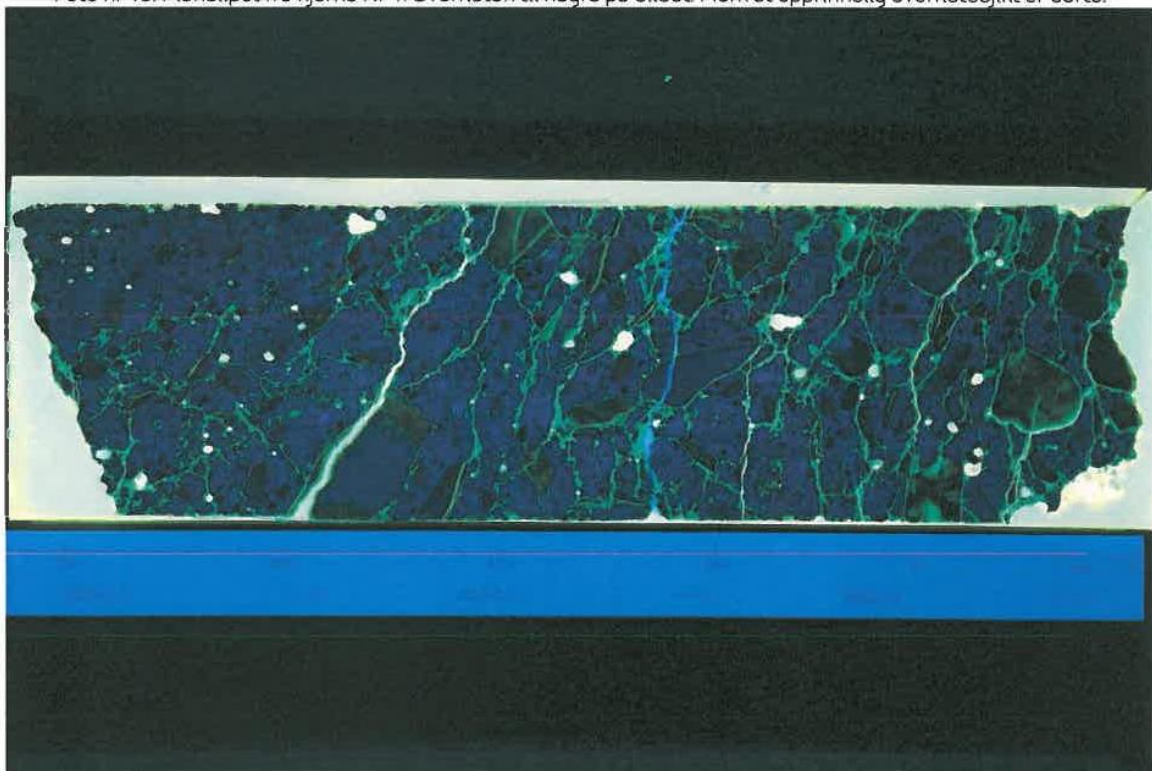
Planslipet fra kjerne Nr 1 fotografert i UV-lys. Rissene er fylt med fluorescerende epoksy, og framkommer som gulgrønne "streker" med denne belsningsformen. Merk at betongen er kraftig opprisset med overflateparallele riss (delaminering).
